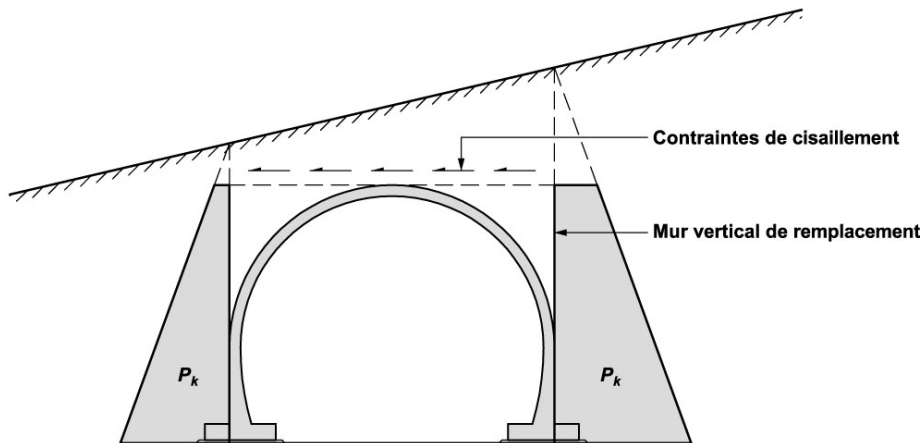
Poussées des terres en présence d'un terrain incliné.
